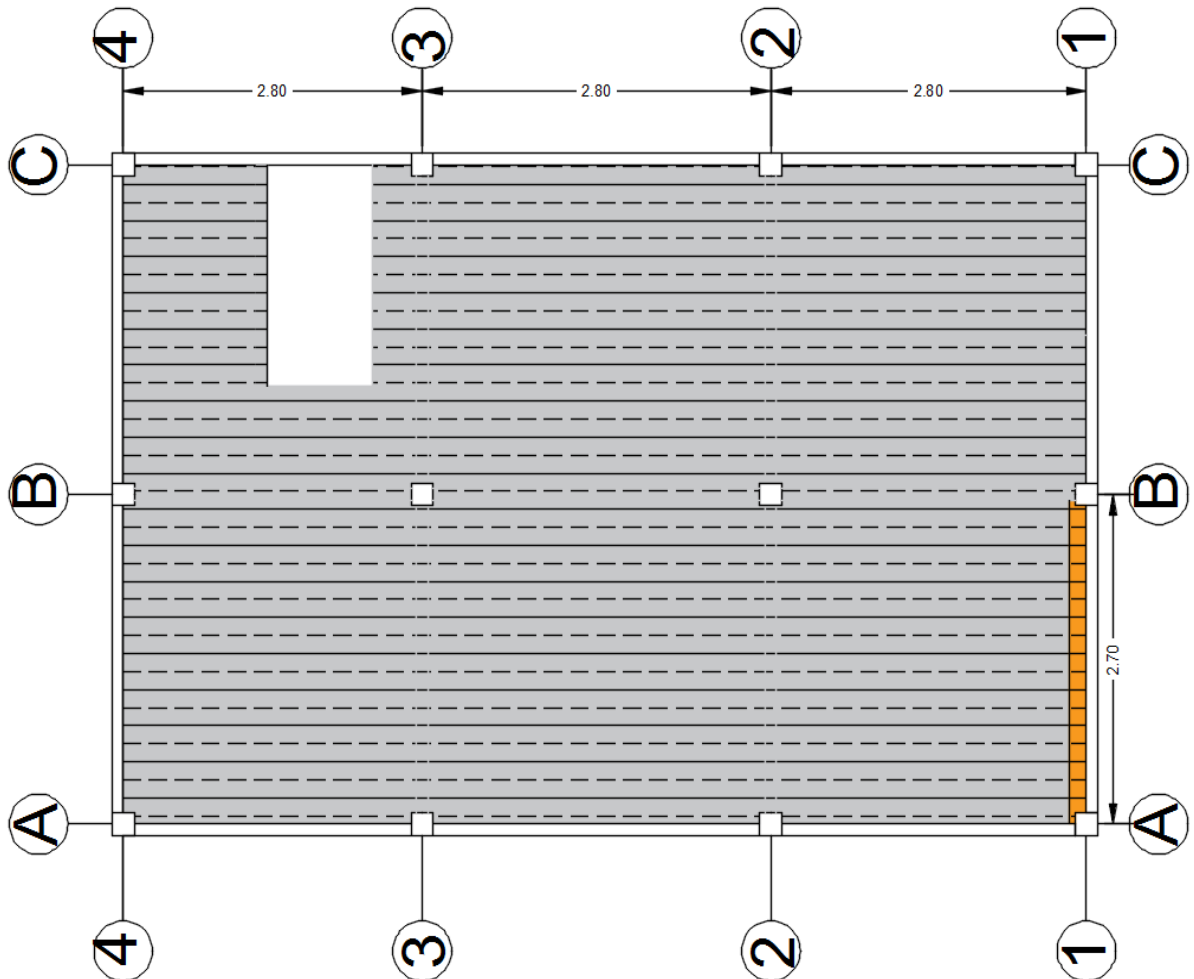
Vista en planta de la viga analizada eje 1 entre a-b
